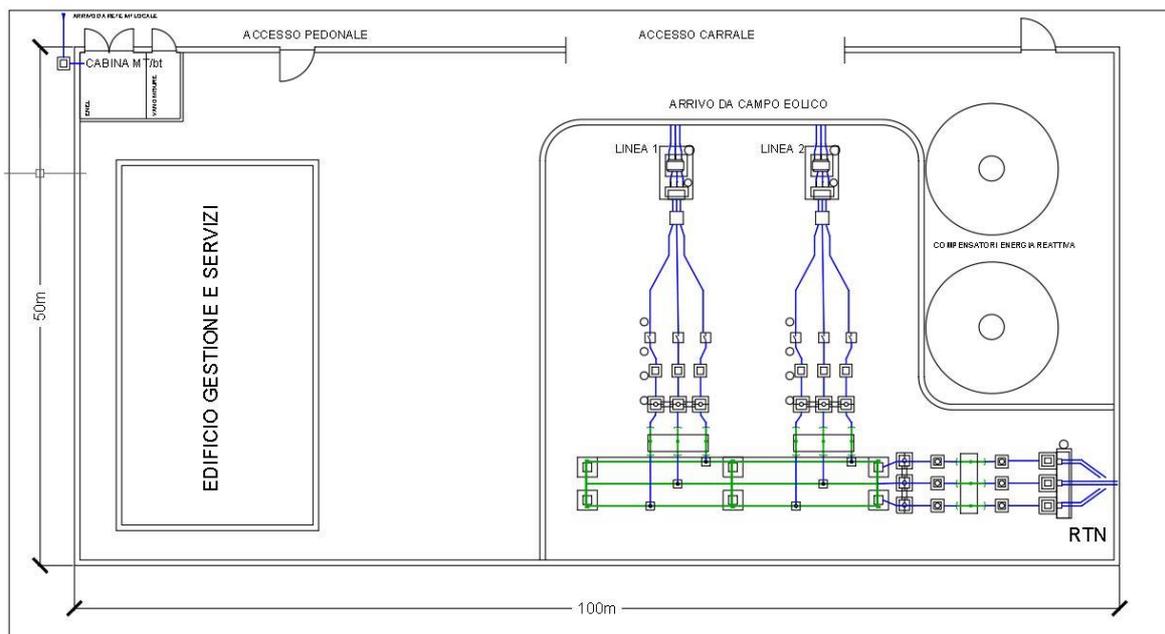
Esempio di schema planimetrico della Sottostazione di misura e consegna
